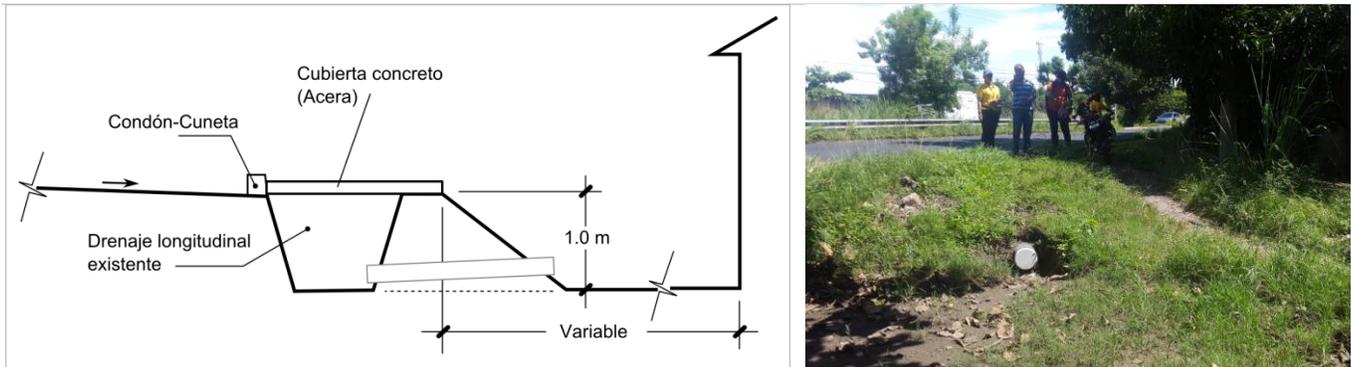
Vista y esquema general de tubería de drenaje instalada por propietarios de terrenos afectados.
